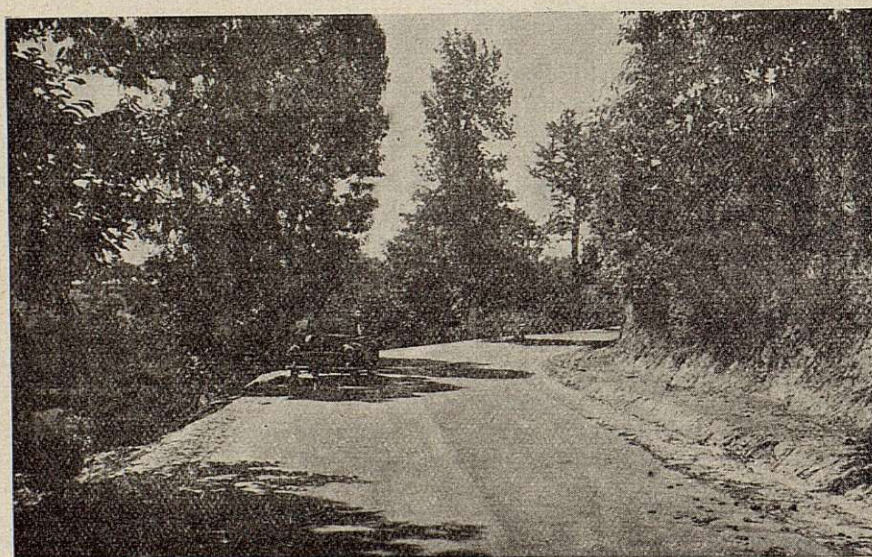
, 3 e 4.—E. N. n.º 102.—Aspectos de um pavimento constituído por um tapêe ligeiro de argamassas betuminosas com 15 m/m. de espessura, construído sobre um macadame de água.
